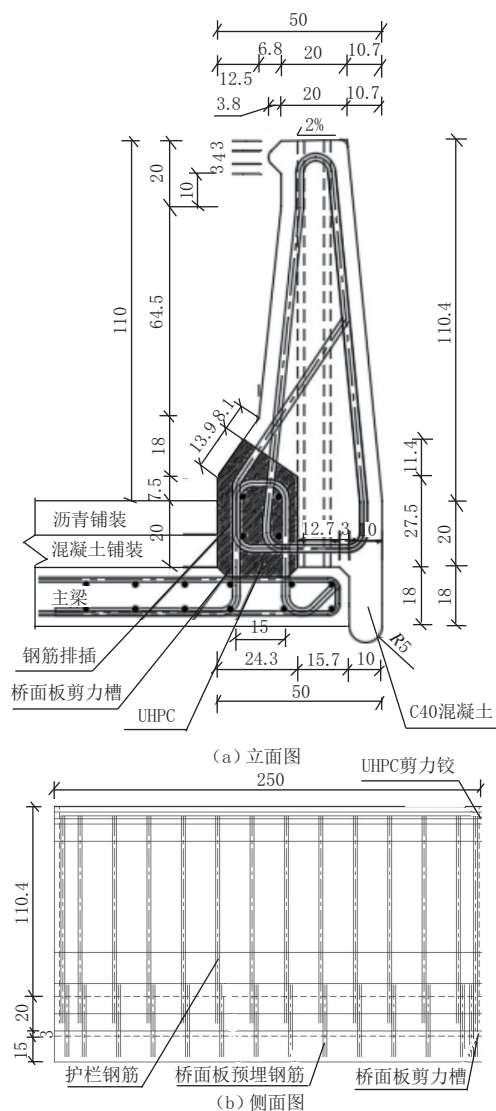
护栏横断面构造及竖向主筋布置(单位:cm)
